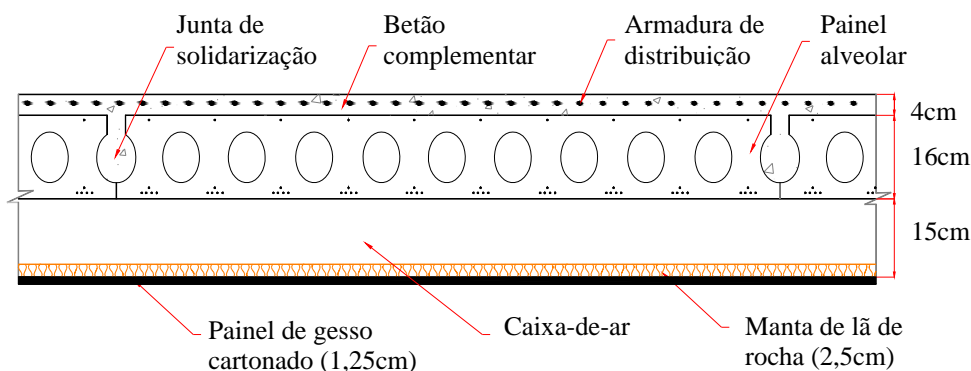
Pavimento em painéis alveolares com tecto falso e isolante térmico no tardoz (Pav8)
